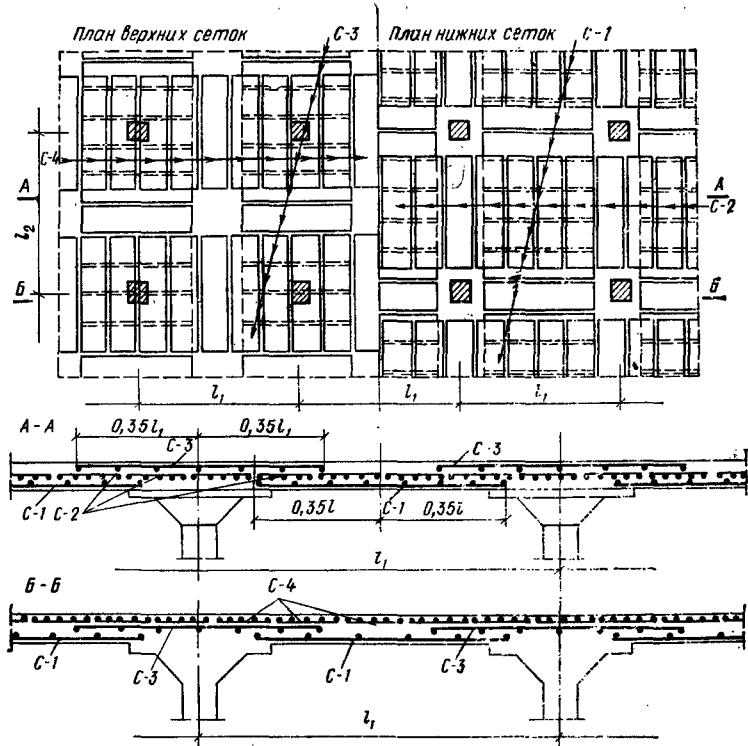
Армирование безбалочного перекрытия узкими сетками
